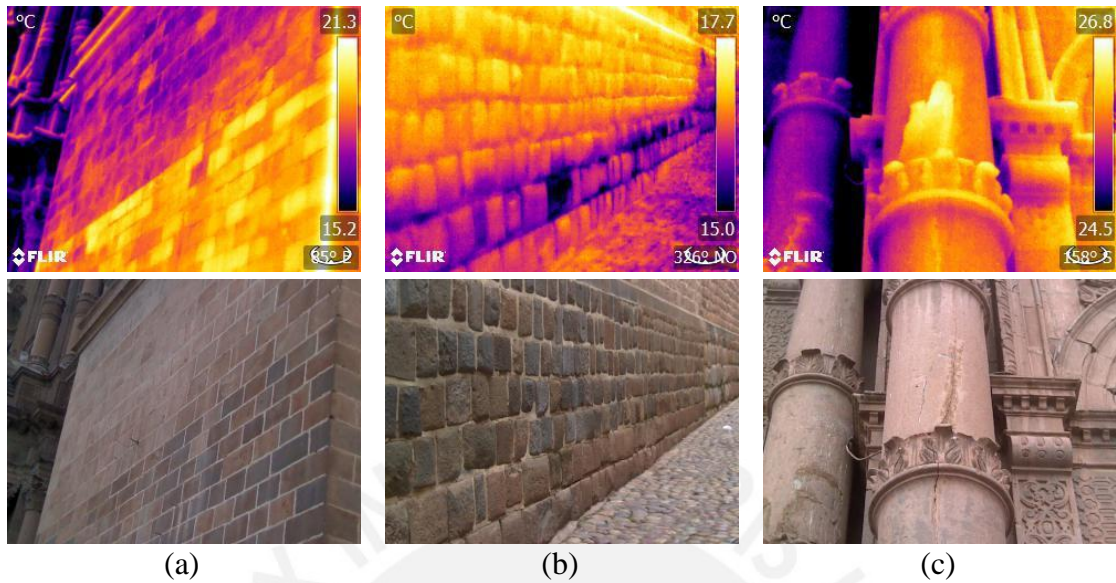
Anomalías detectadas con IRT pasiva: (a) diferentes materiales ubicados en la fachada, (b) humedad en un muro lateral, y (c) grietas y desprendimientos en un pilar
